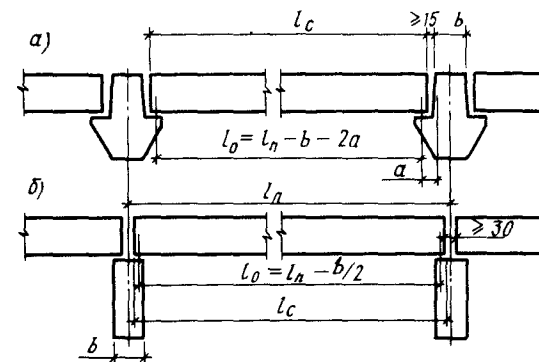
Расчетные пролеты плит при опирании: а — на полки ригелей таврового сечения; б — поверху на ригели прямоугольного сечения
